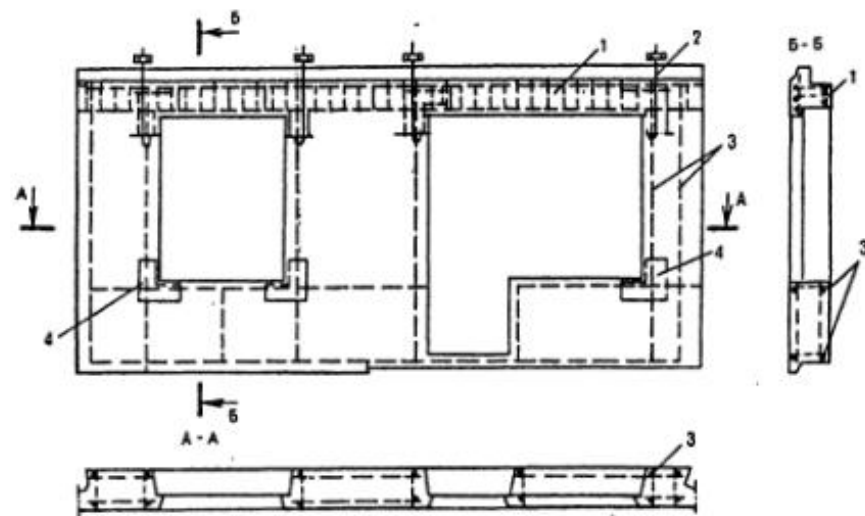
Схема армирования однослойной легкобетонной панели: 1 - арматурный каркас перемычки; 2 - подъемный элемент; 3 - контурный арматурный каркас; 4 - Г-образная арматурная сетка в фасадном слое
